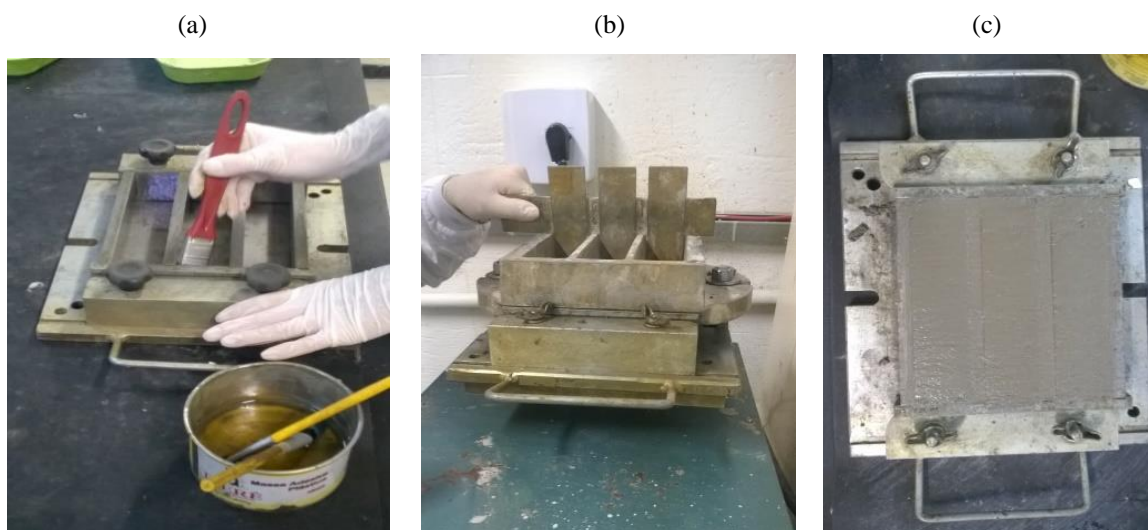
Etapas e aparelhagem da moldagem dos corpos de prova -
